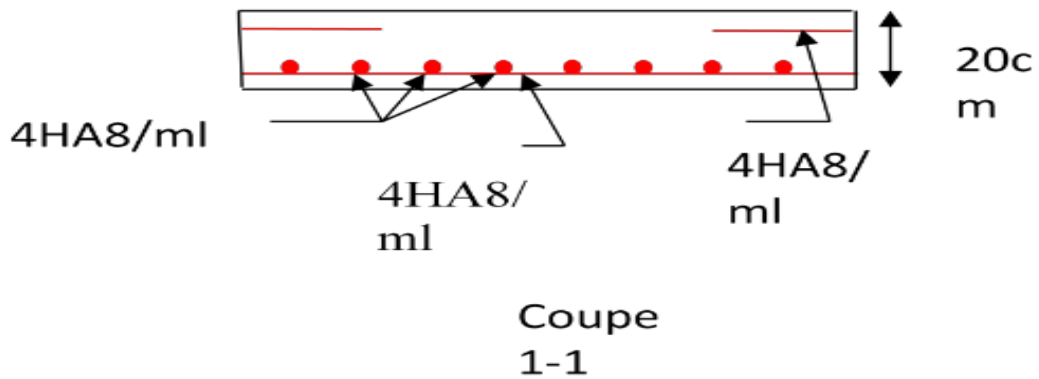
Schéma de ferrailage de la dalle (vue de coté).
